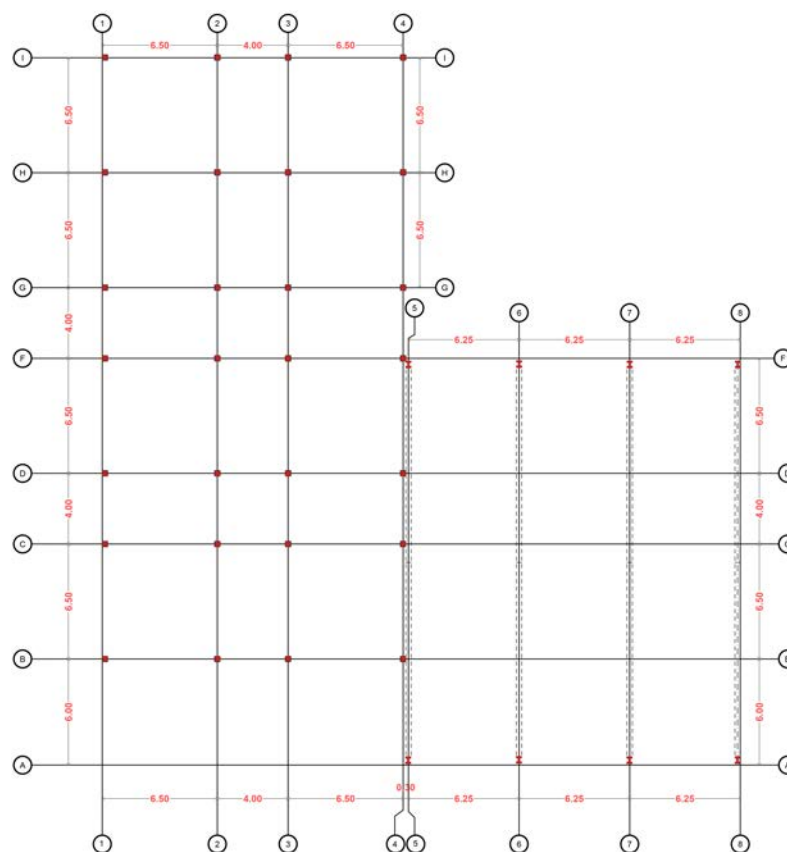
Ejes y distribución estructural del primero y segundo bloque. Elaboración: Autor.
